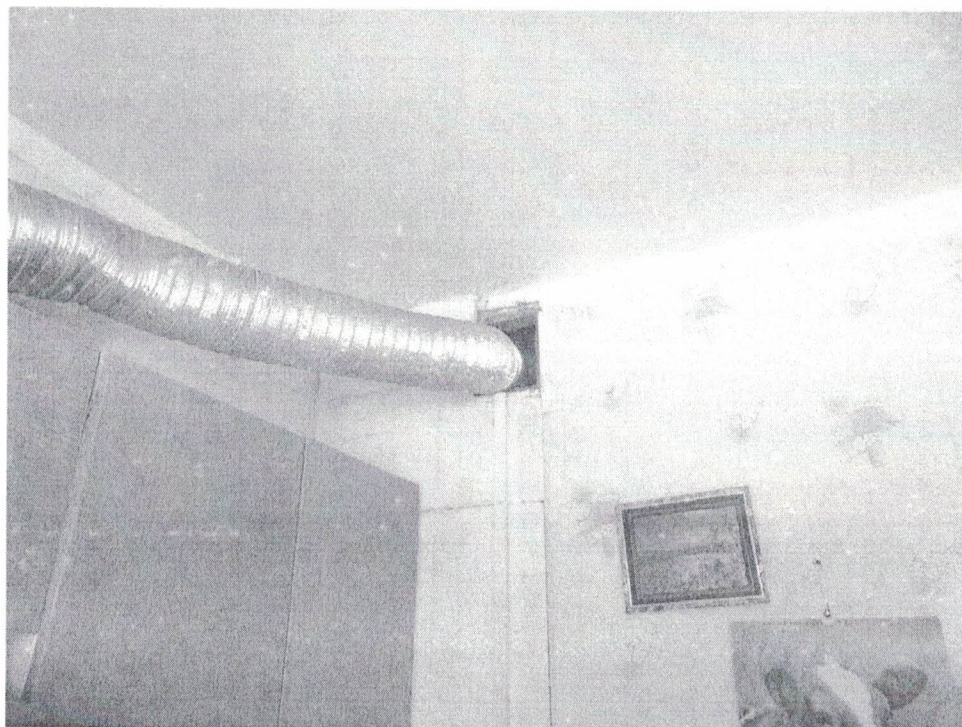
Вентиляционный канал на кухне. Третий этаж квартира №52.
